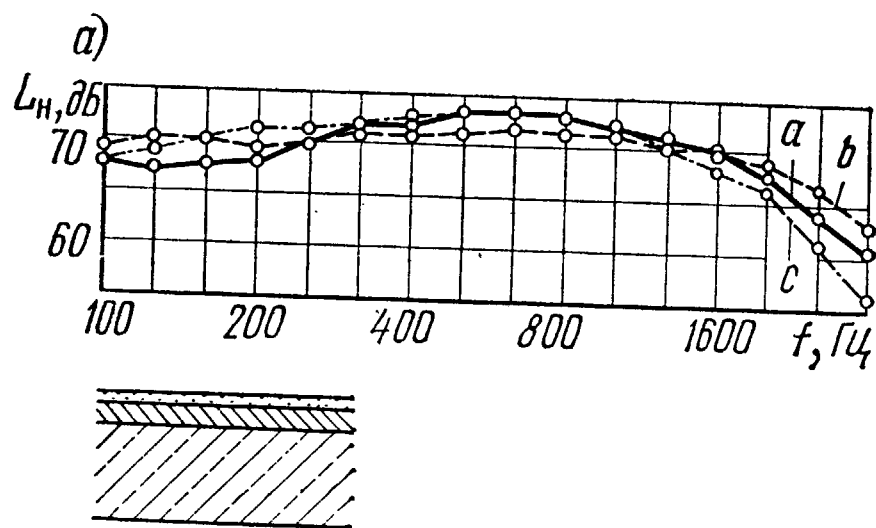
Звукоизоляция конструкций перекрытий по железобетонным плитам [31]
